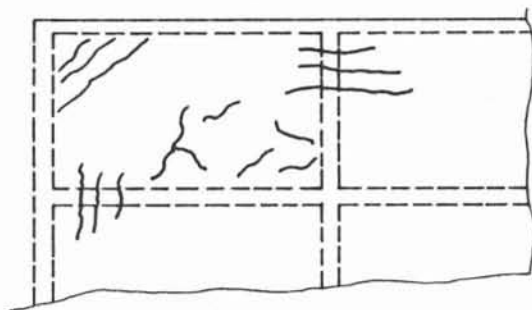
Fissuração por dessecação superficial em lajes contínuas.
